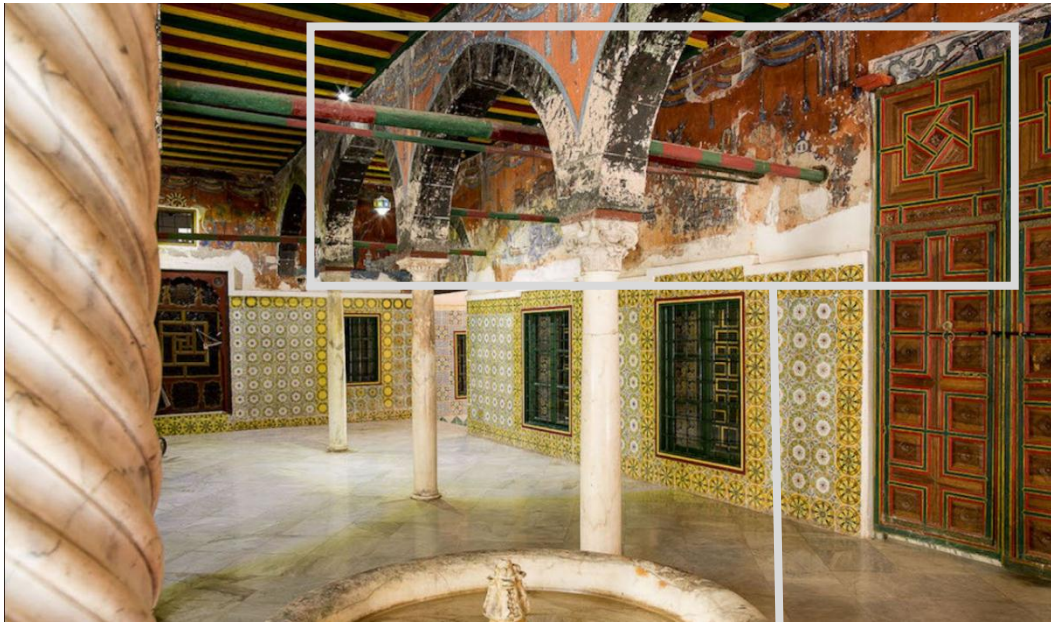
Photo intérieure du palais. Photo prise par : Kays Djilali. Traitement : Auteure 2023
